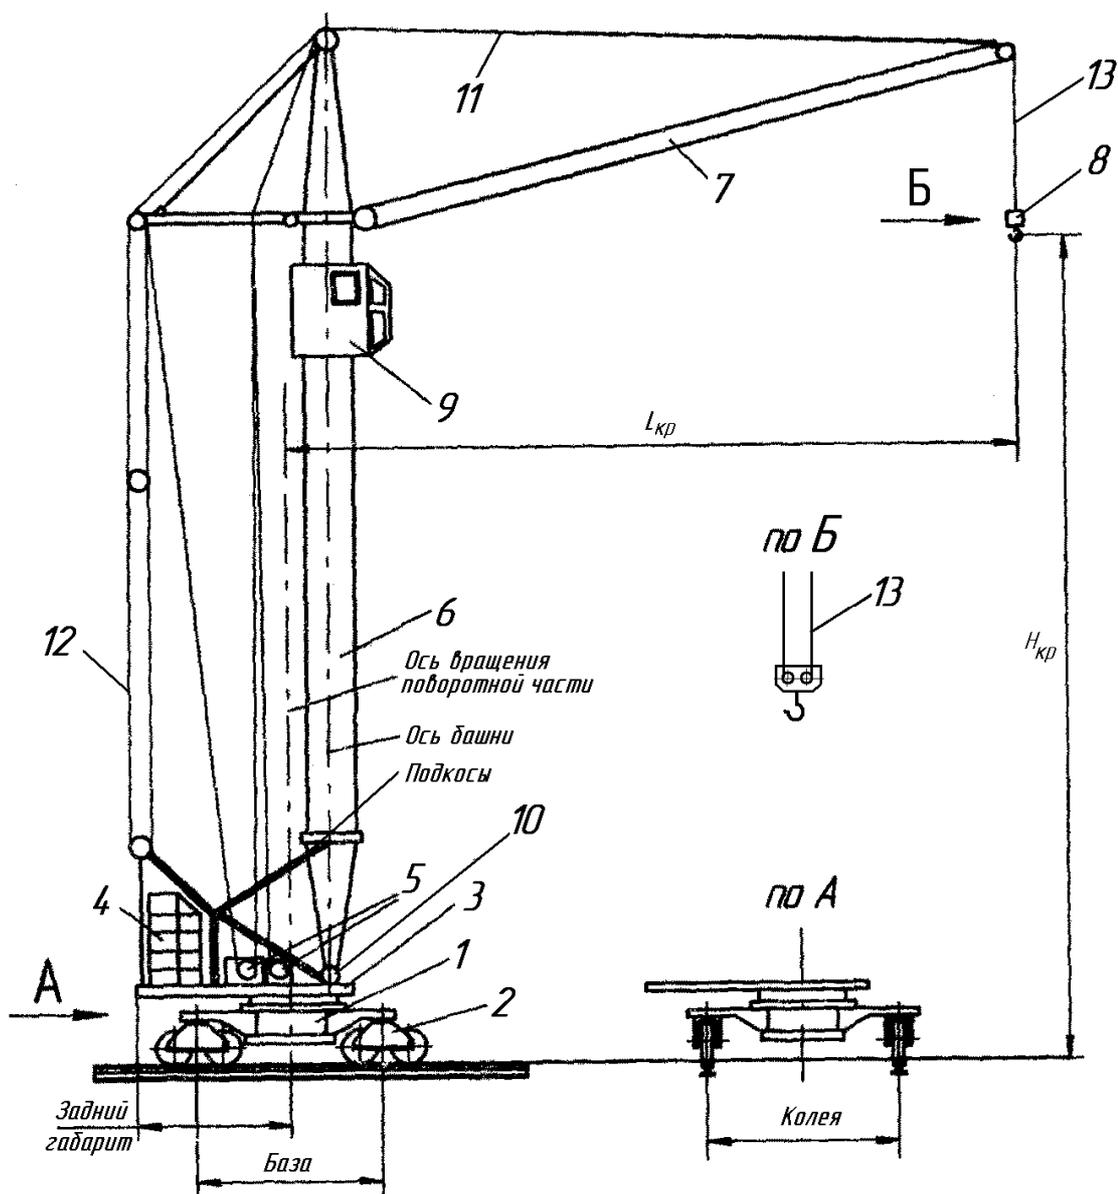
Кран башенный с поворотной башней КБ-302А:
